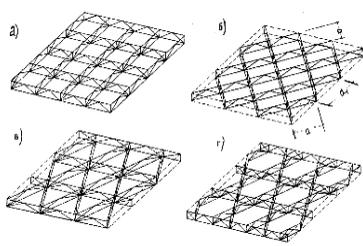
Схема покрытий из решетчатых пирамид: а, б – из пирамид с квадратной основой (пентаэдров); в – из пирамид (тетраэдров); г – из пирамид с шестиугольным основанием (гептаэдров)
